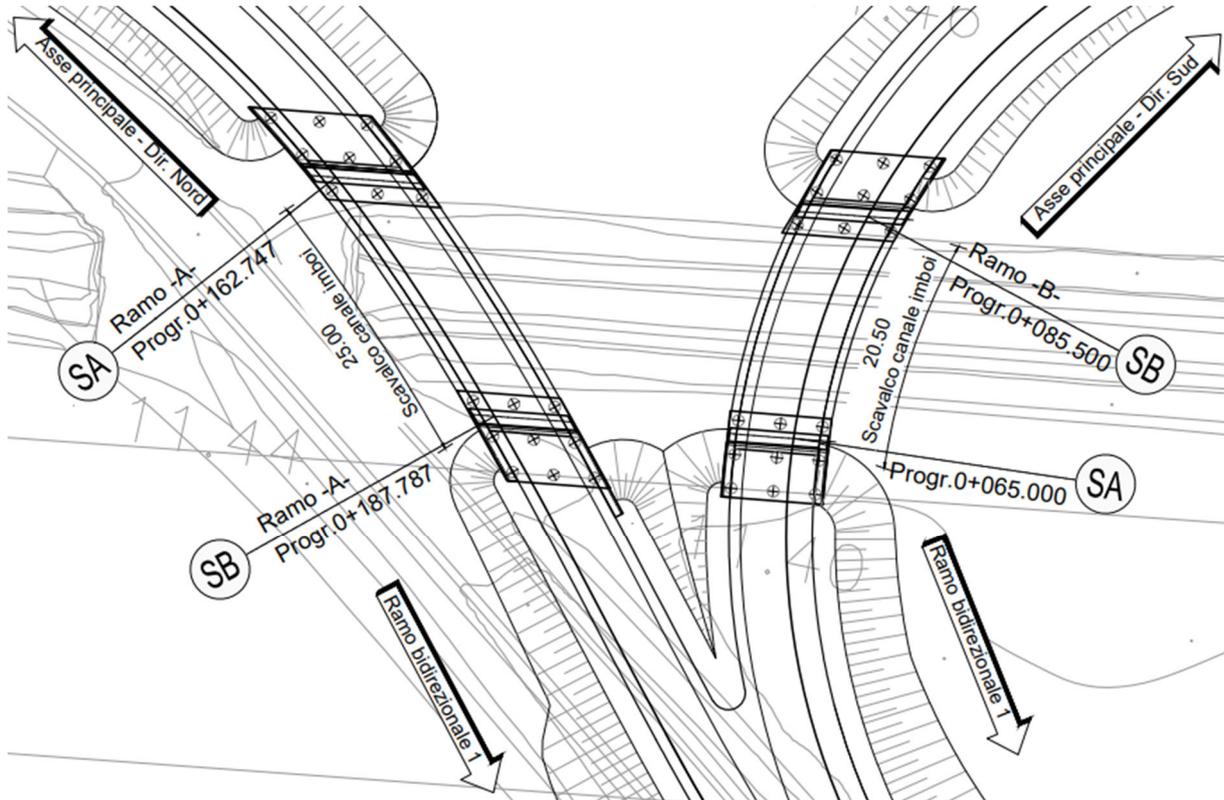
Inquadramento planimetrico VI06-VI03
